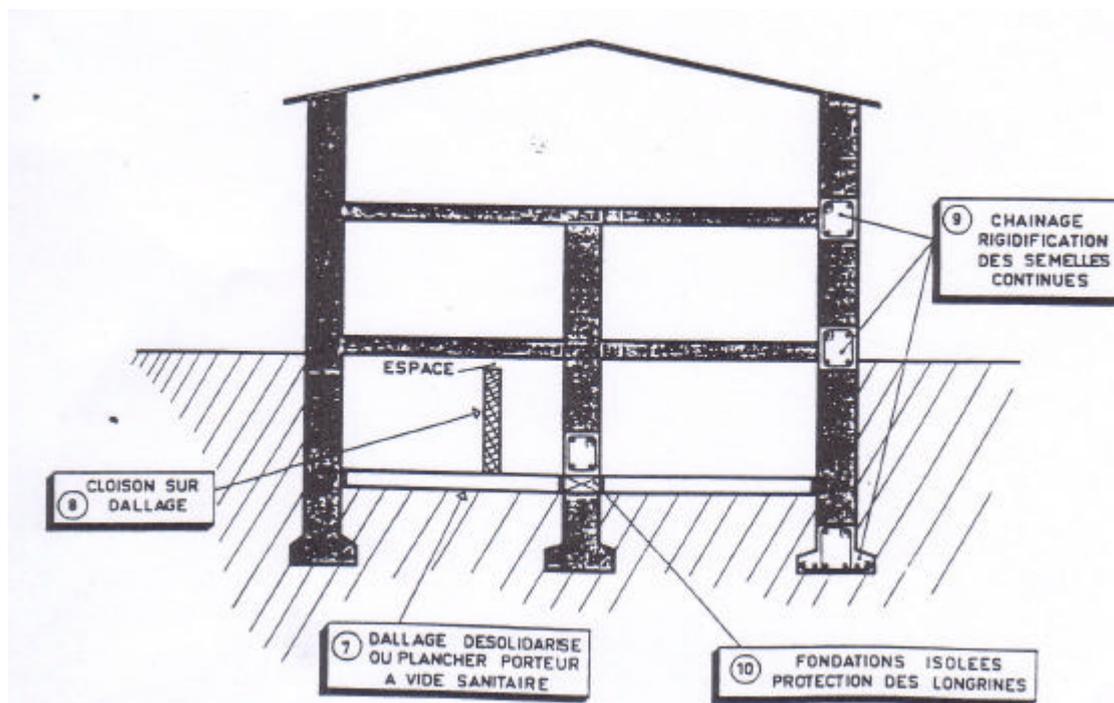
Mesures destinées à adapter la structure à un gonflement du sol de fondation
